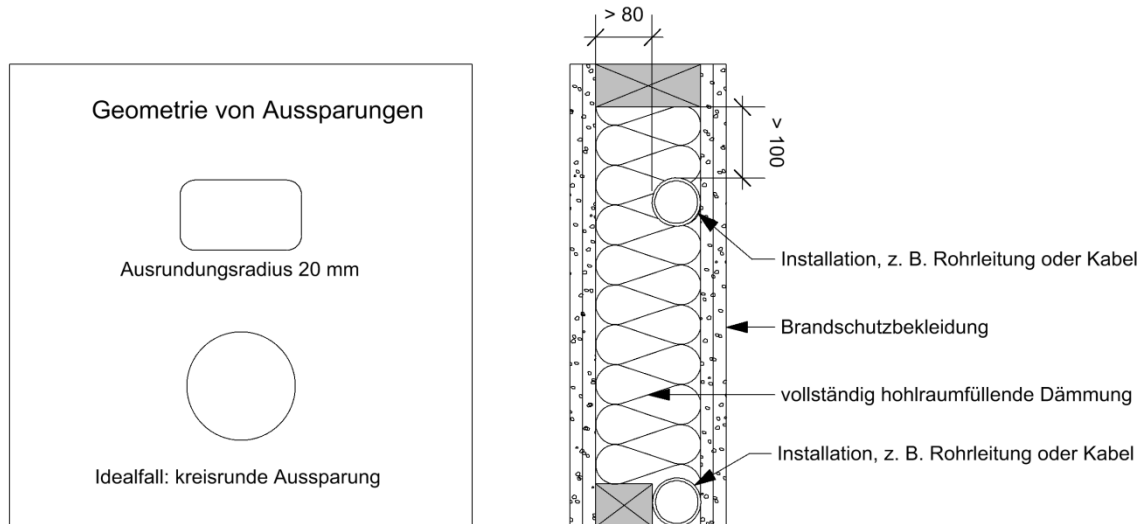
Grundsätze zum Einbau von Installationen und Öffnungen in der Kapselbekleidung in hochfeuerhemmenden Holzbauteilen
